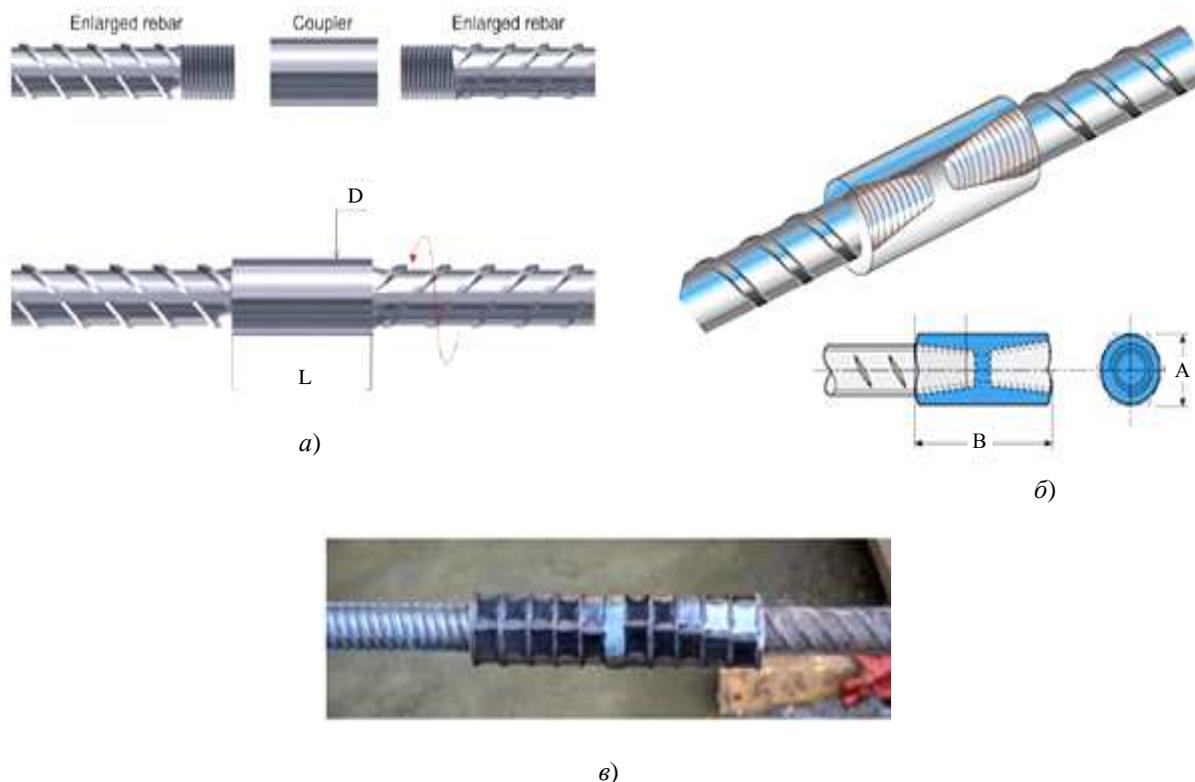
Конструктивное решение стыка стержней продольной арматуры колонны с применением специальных механических устройств:
